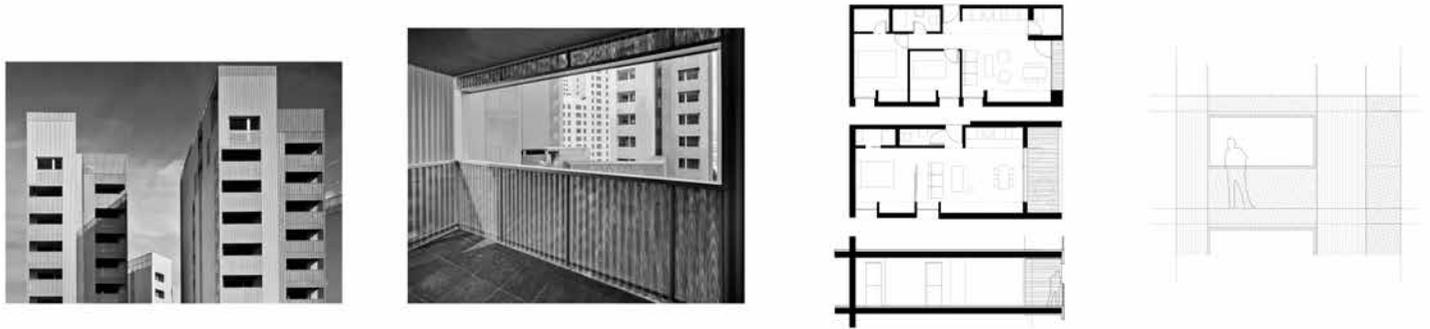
COSLADA, alzado exterior, vista espacio intermedio, planta y sección
